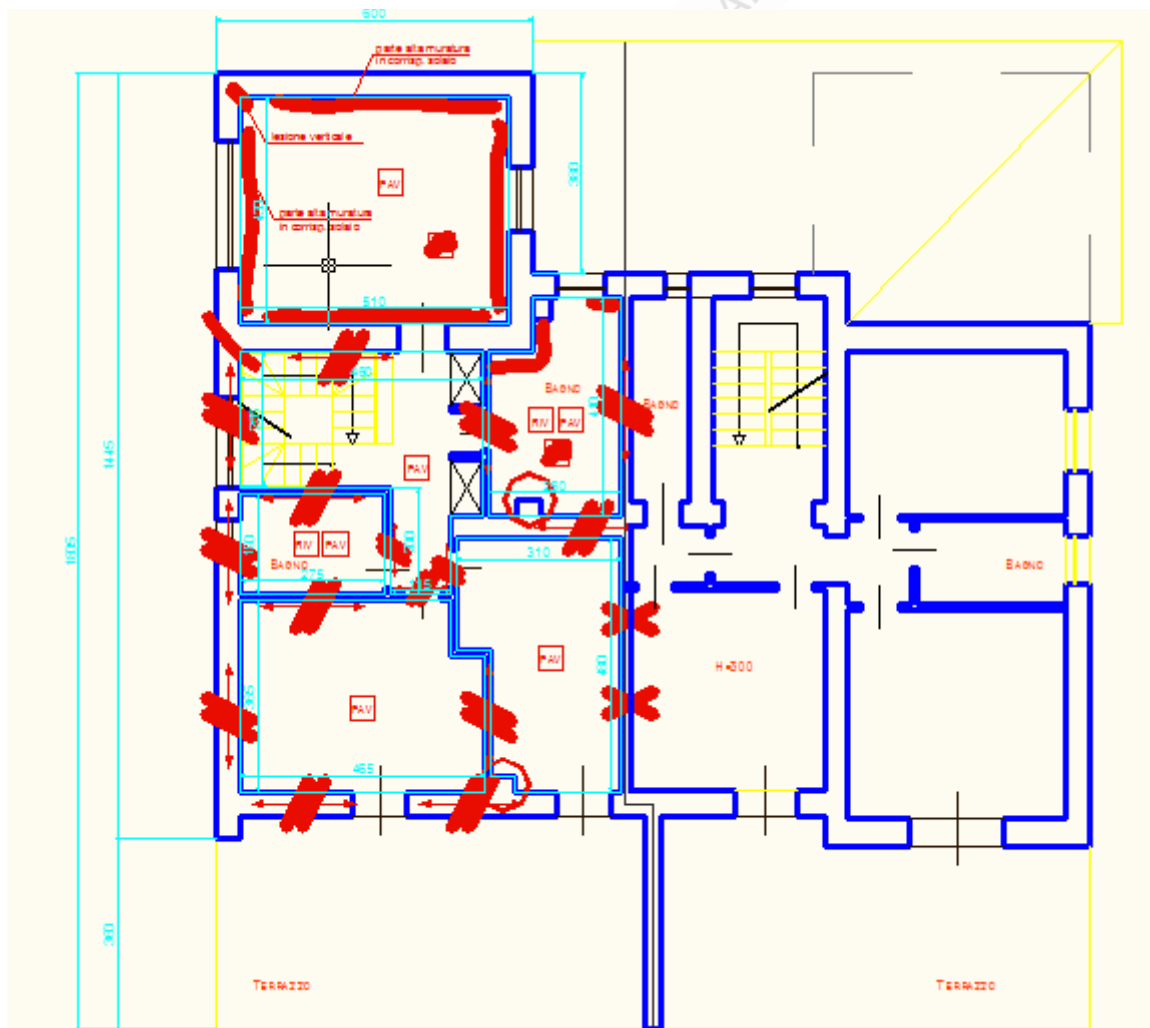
Planimetria del piano primo in cui sono riportati i danni subiti dalla struttura.
